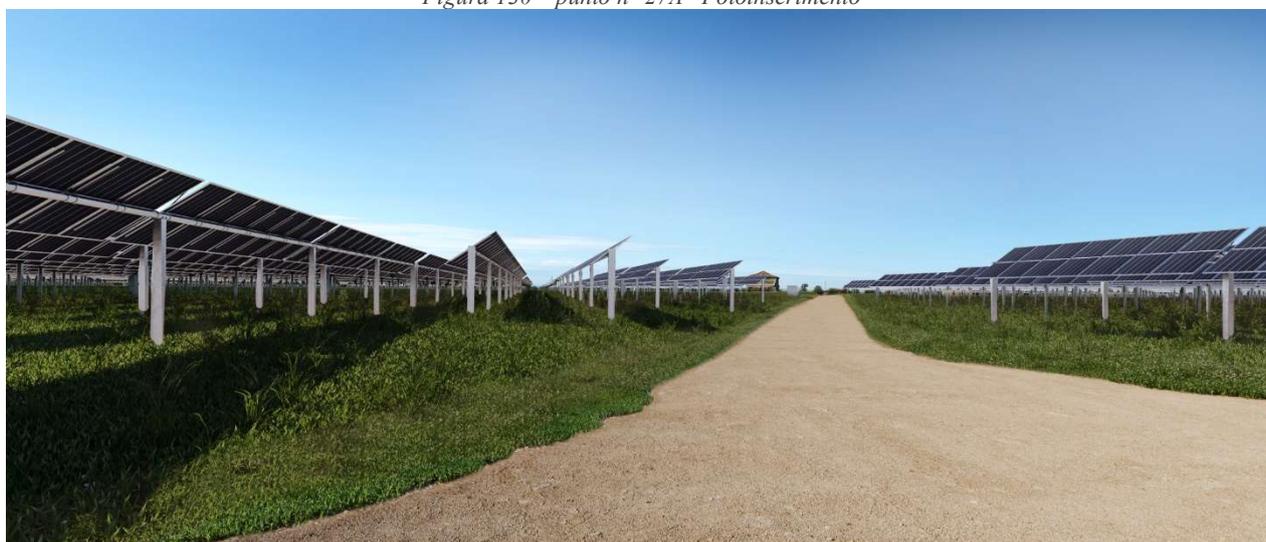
punto n° 27A– Fotoinserimento con mitigazione
